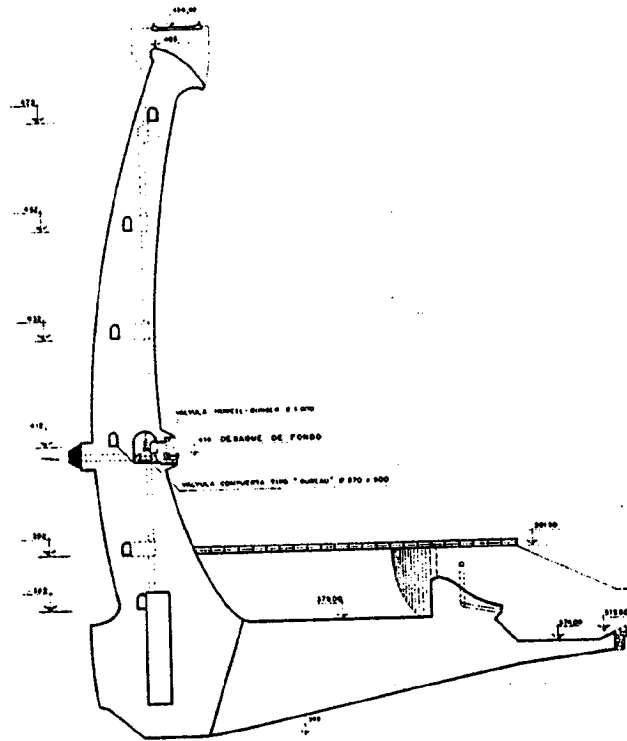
Alzado y sección tipo de presa bóveda.
